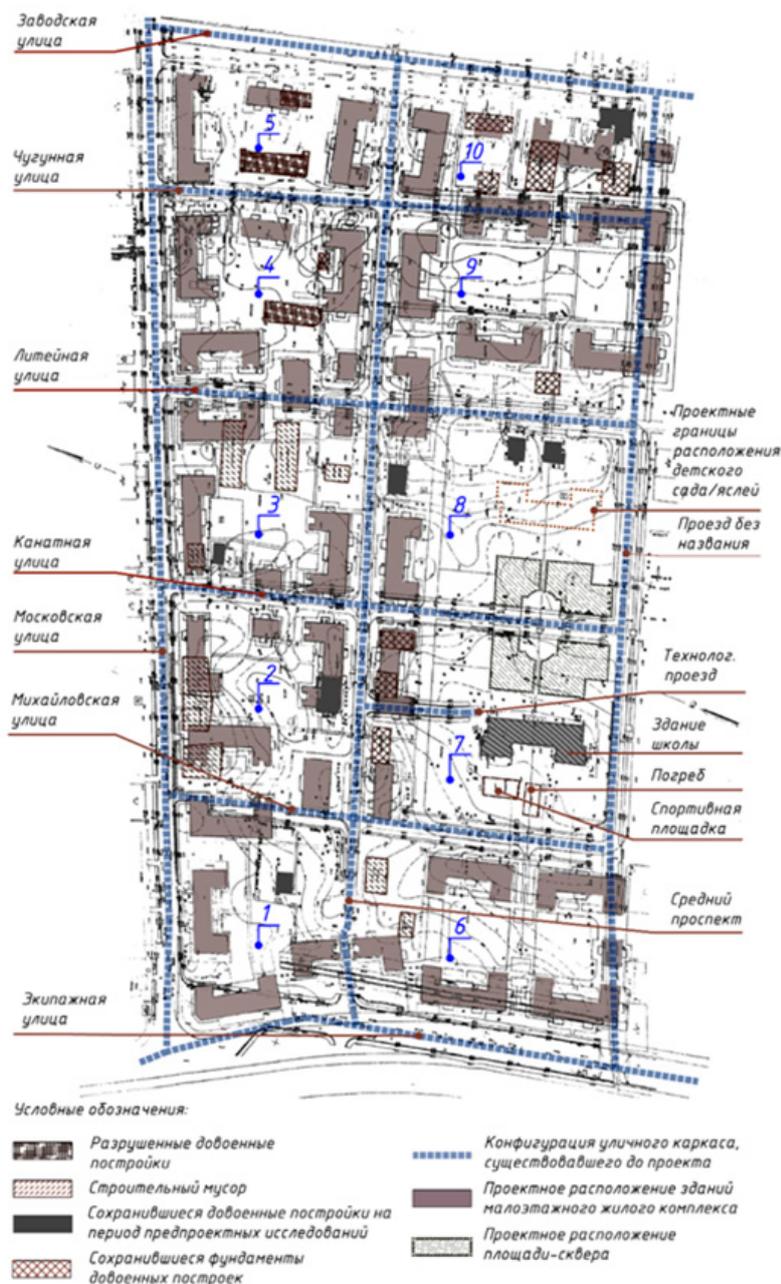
Схема проектного размещения зданий малоэтажного жилого комплекса, совмещенная с предпроектным планом исследования местности. Картографической основой является план земельного участка, расположенного в Ленинграде в Володарском районе по Московской улице, составленный по материалам съемки 1941–1946 года. (Исполнитель: Трест Геодезических работ и Инженерных Изысканий. Заказ №297-46) Проектная документация Шифр 958. Лист №1. От 10 июня 1946 г. Проектное размещение зданий комплекса обозначено на основе плана планировки и благоустройства квартала малоэтажного строительства за Пролетарским заводом. Шифр 958. Марка АП. Лист 1. Материалы представлены архивом «ЛенНИИпроект».
